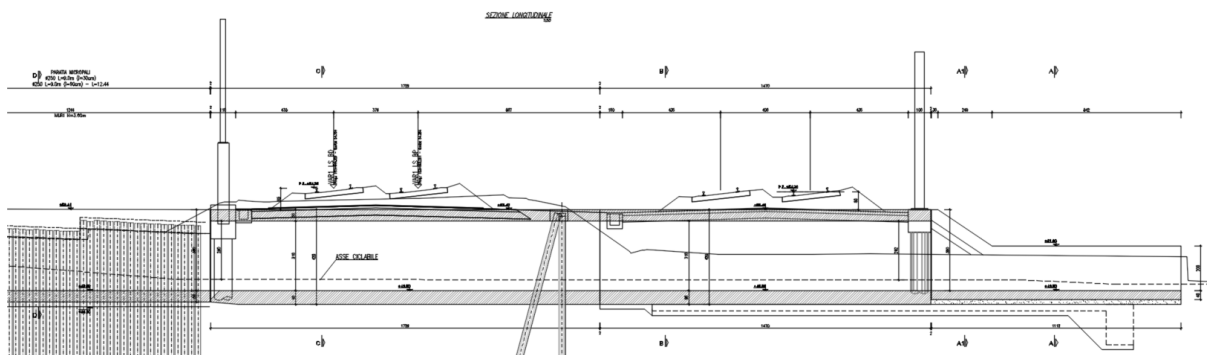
Sezione longitudinale Sottovia IN04 con struttura definitiva
